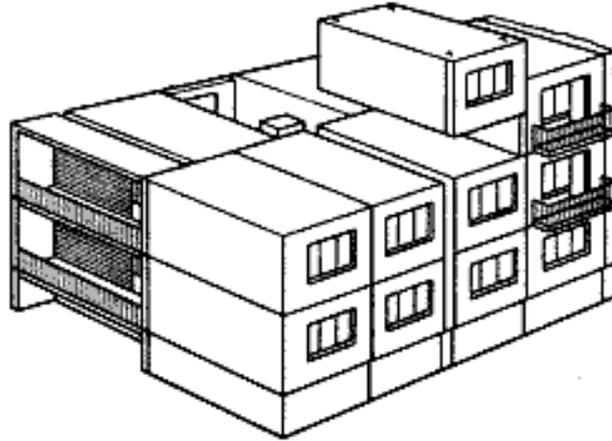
Конструктивная схема дома из блоков–комнат
